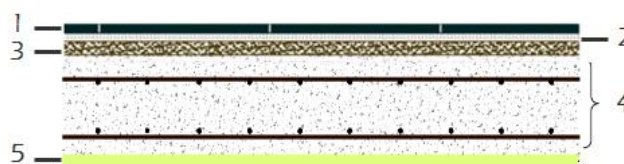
Coupe d'un plancher d'étage courant en dalle pleine.
